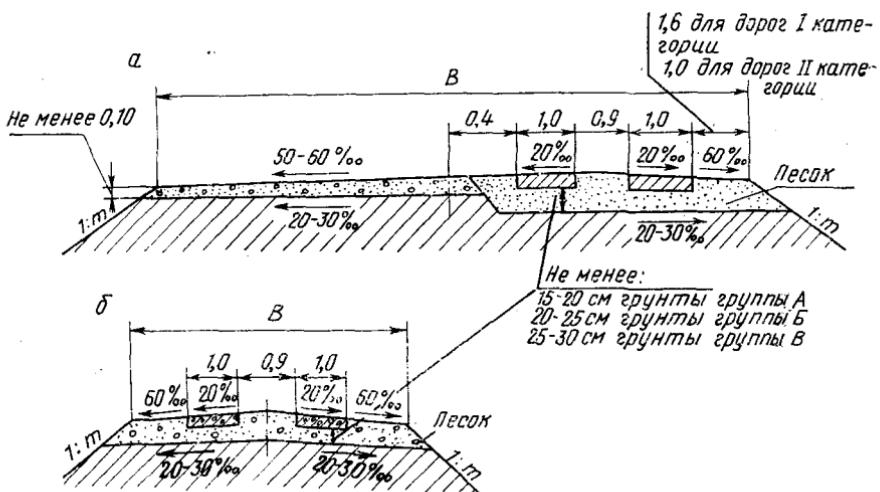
Дорожные одежды колейного типа с покрытием из железобетонных плит:
